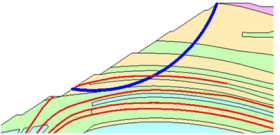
解析モデル図 (⑤-⑤' 断面)
